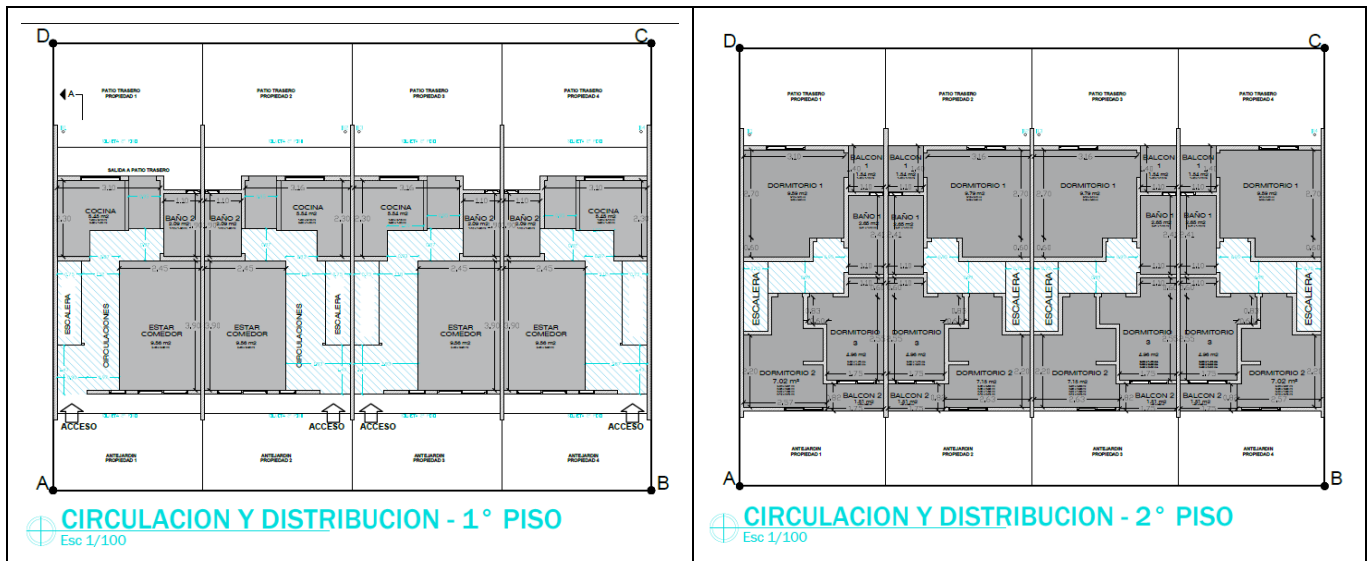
"Vista en planta de la arquitectura de la vivienda; (IZQ) 1°Piso; (DER) 2°Piso".
